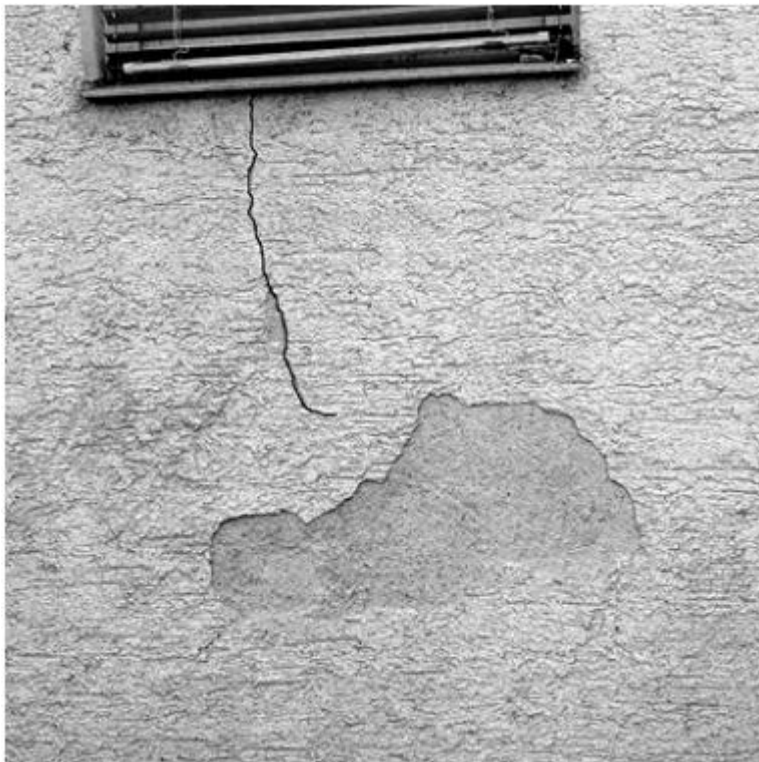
Трещина на стене и повреждение штукатурки на фасаде здания, расположенного по соседству с объектом 32, без применения Систем Внешней Изоляции Стен (Eberstrasse,2). Трещина на стене под окном происходит в слое штукатурки. Завершающий слой штукатурки частично отошел от слоя грунтовки. Таких повреждений можно избежать, применяя СФТК с помощью эффекта «разделения» мягким изоляционным слоем, так же как с использованием пластических добавок и укрепления штукатурки.
